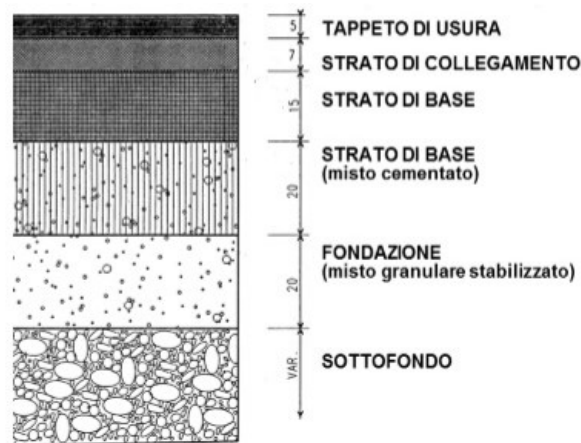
Stratigrafia di un pacchetto strutturale di una pavimentazione stradale semirigida
